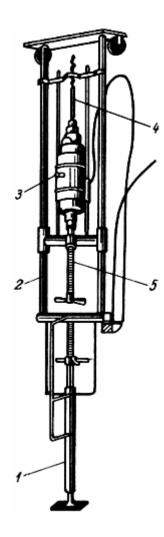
Устройство для создания давления на сверло при сверлении отверстий в стенах и перекрытиях 1 - основание станка; 2 - рама станка; 3 - электрическая дрель; 4 - сменное сверло; 5 - выдвижная труба с нарезкой.
